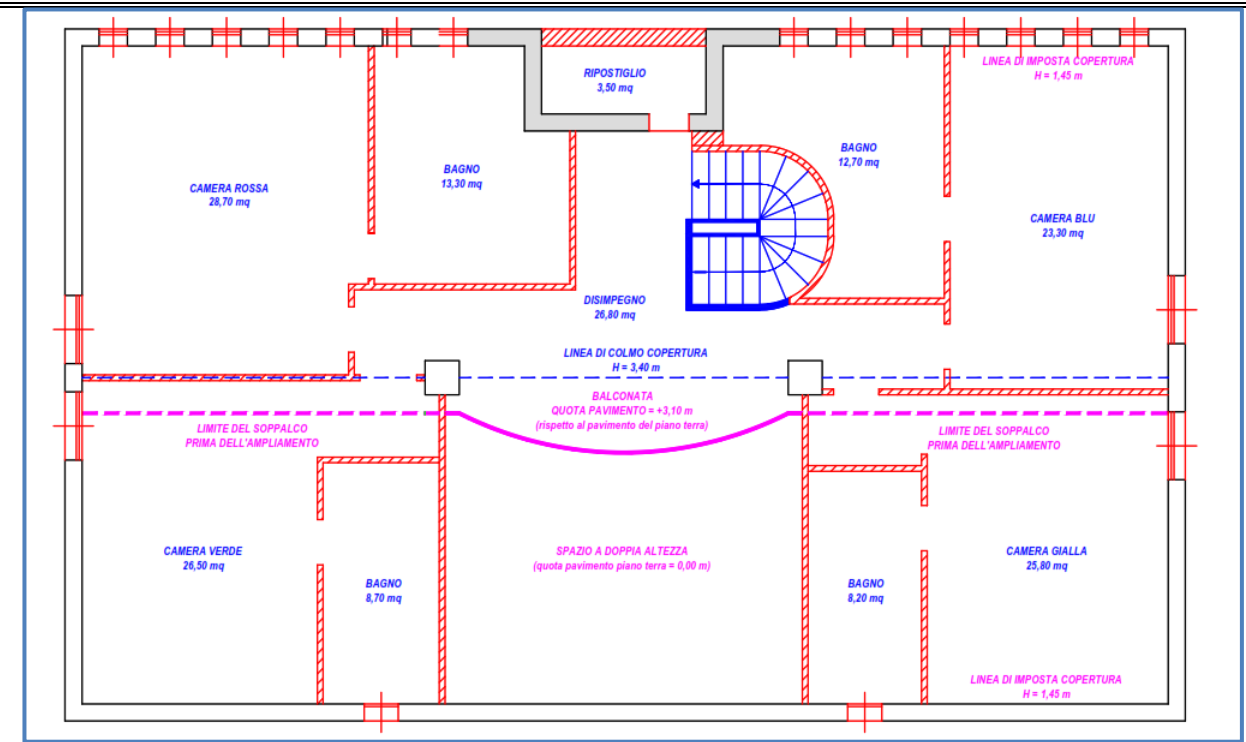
estratto del rilievo redatto dal C.T. del fallimento per il piano soppalco
